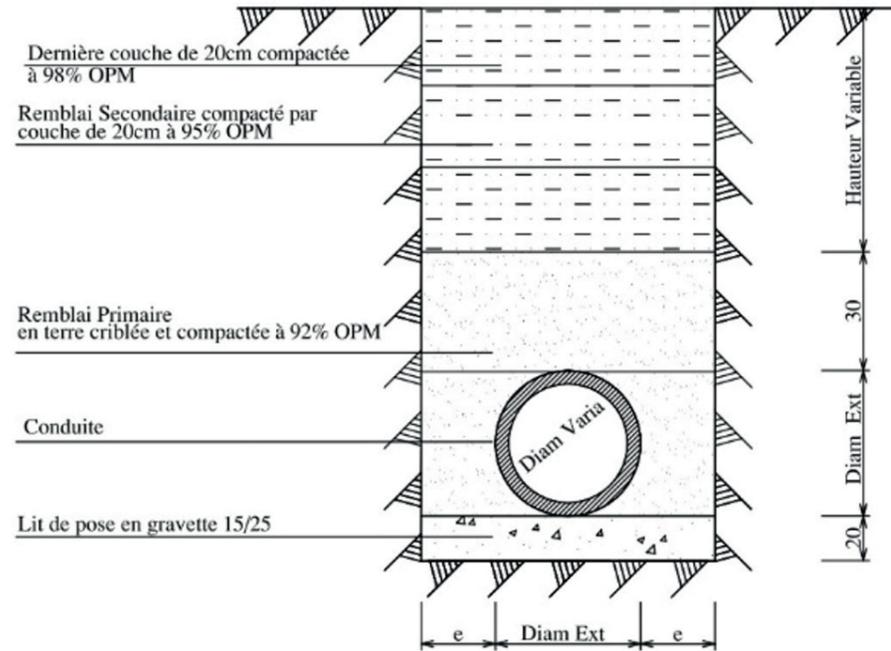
TRANCÉE TYPE POUR CONDUITE CIRCULAIRE
